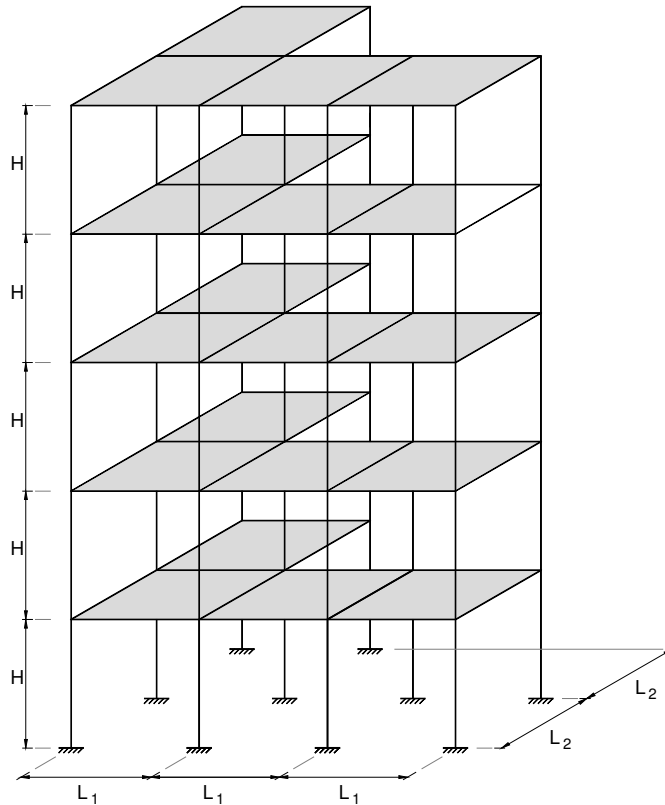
Pórtico 3D com assimetria em planta. Esquema estrutural.
